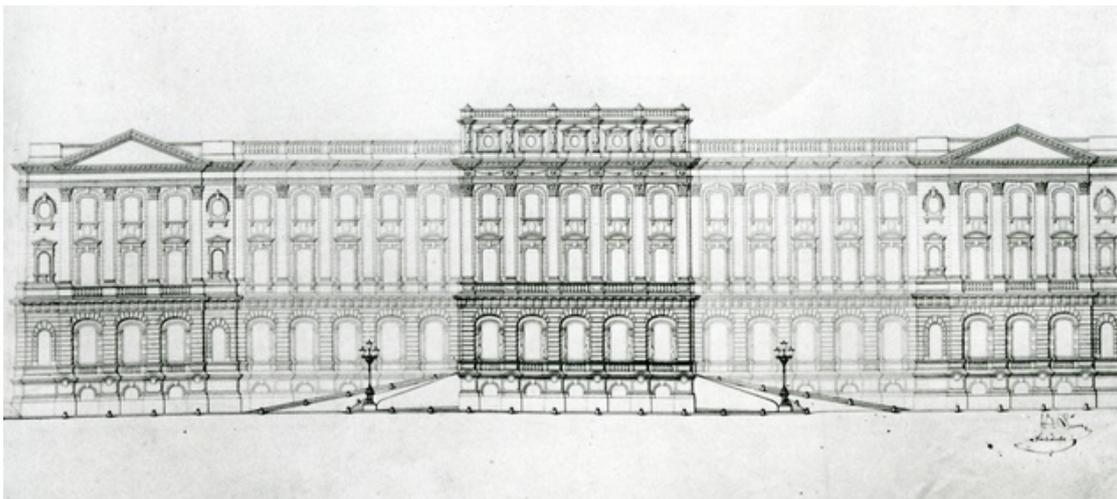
Skizze 18, Fassadenriss
